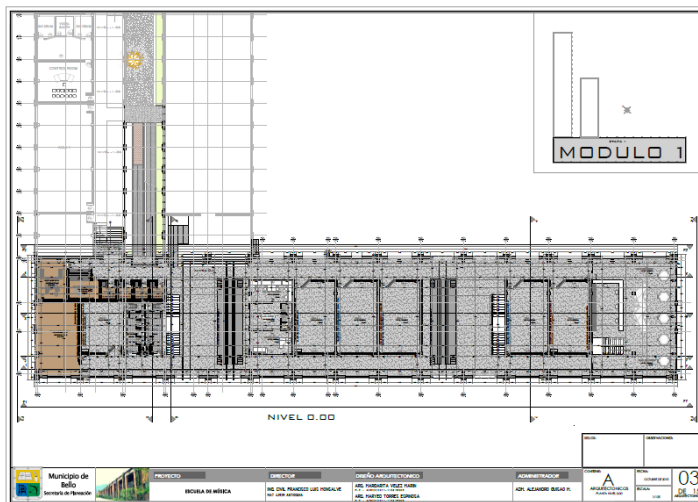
Planimetría Escuela de música, proyecto estratégico de apoyo al macroproyecto urbano.
